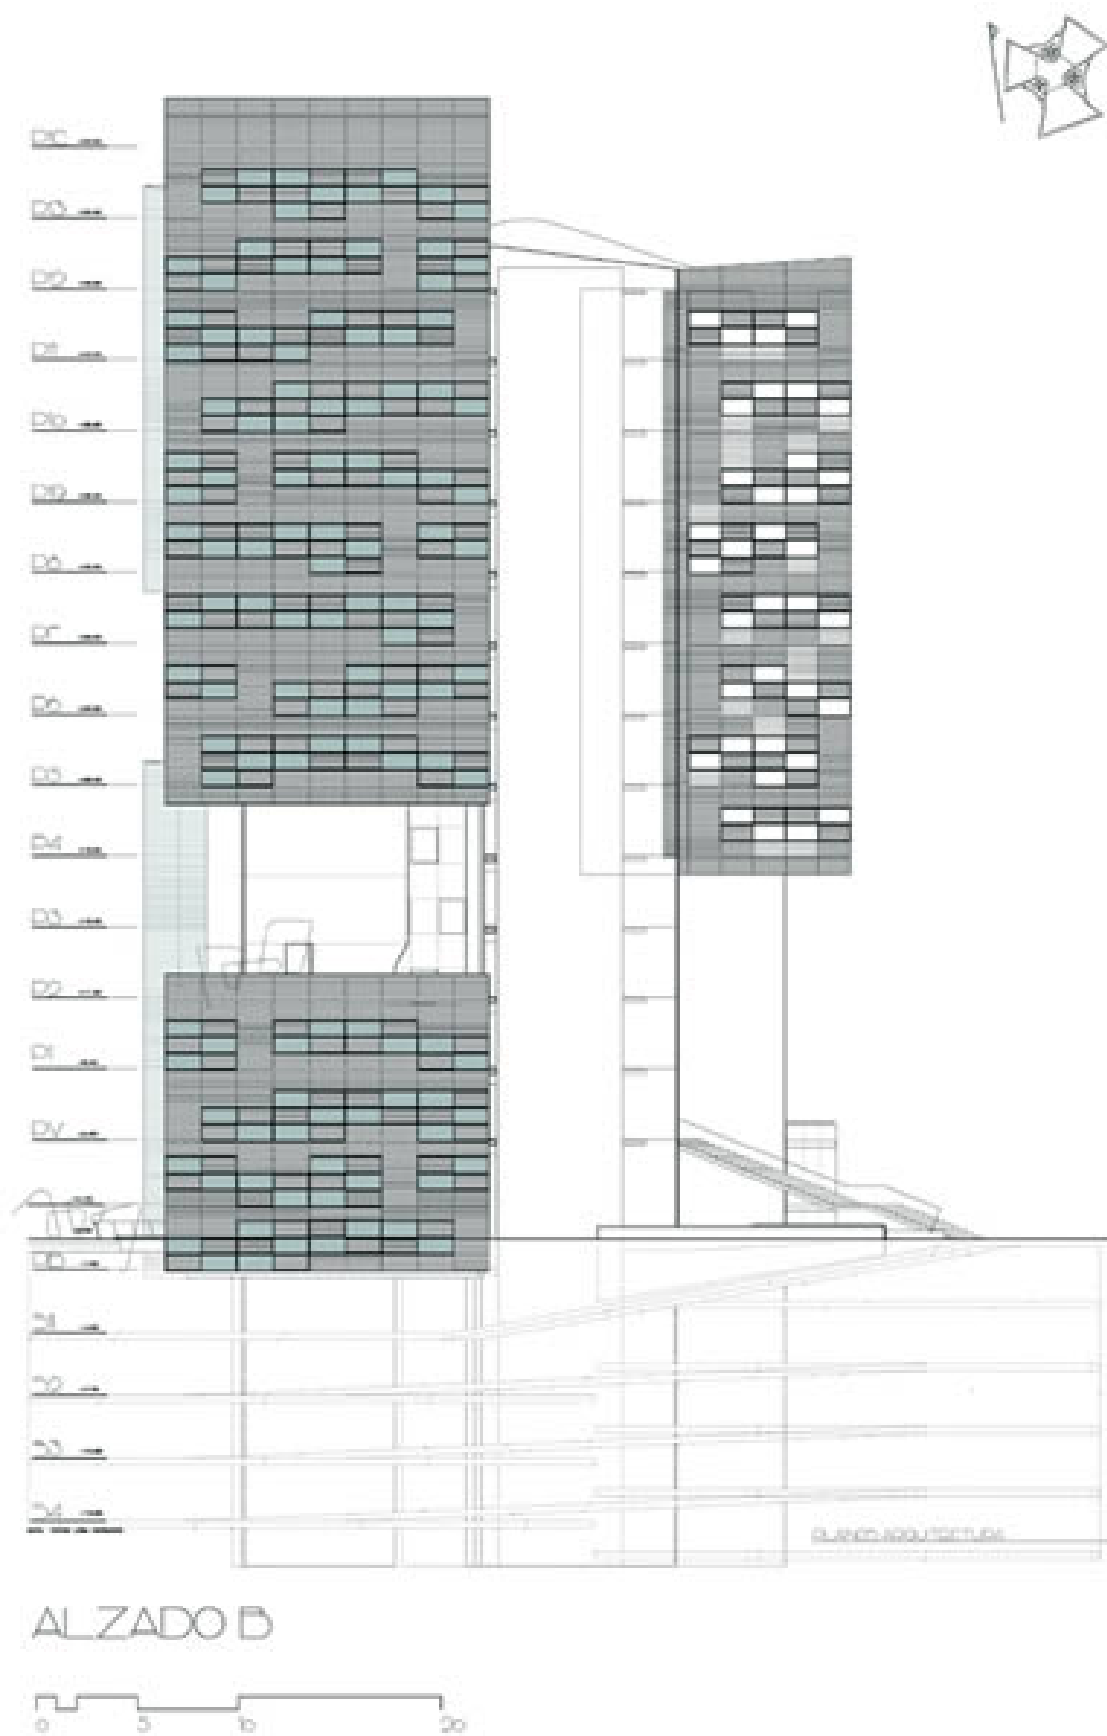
Alzado B. Documentos de Arquitectura nº 60. Revista del Colegio de Arquitectos de Almería.
